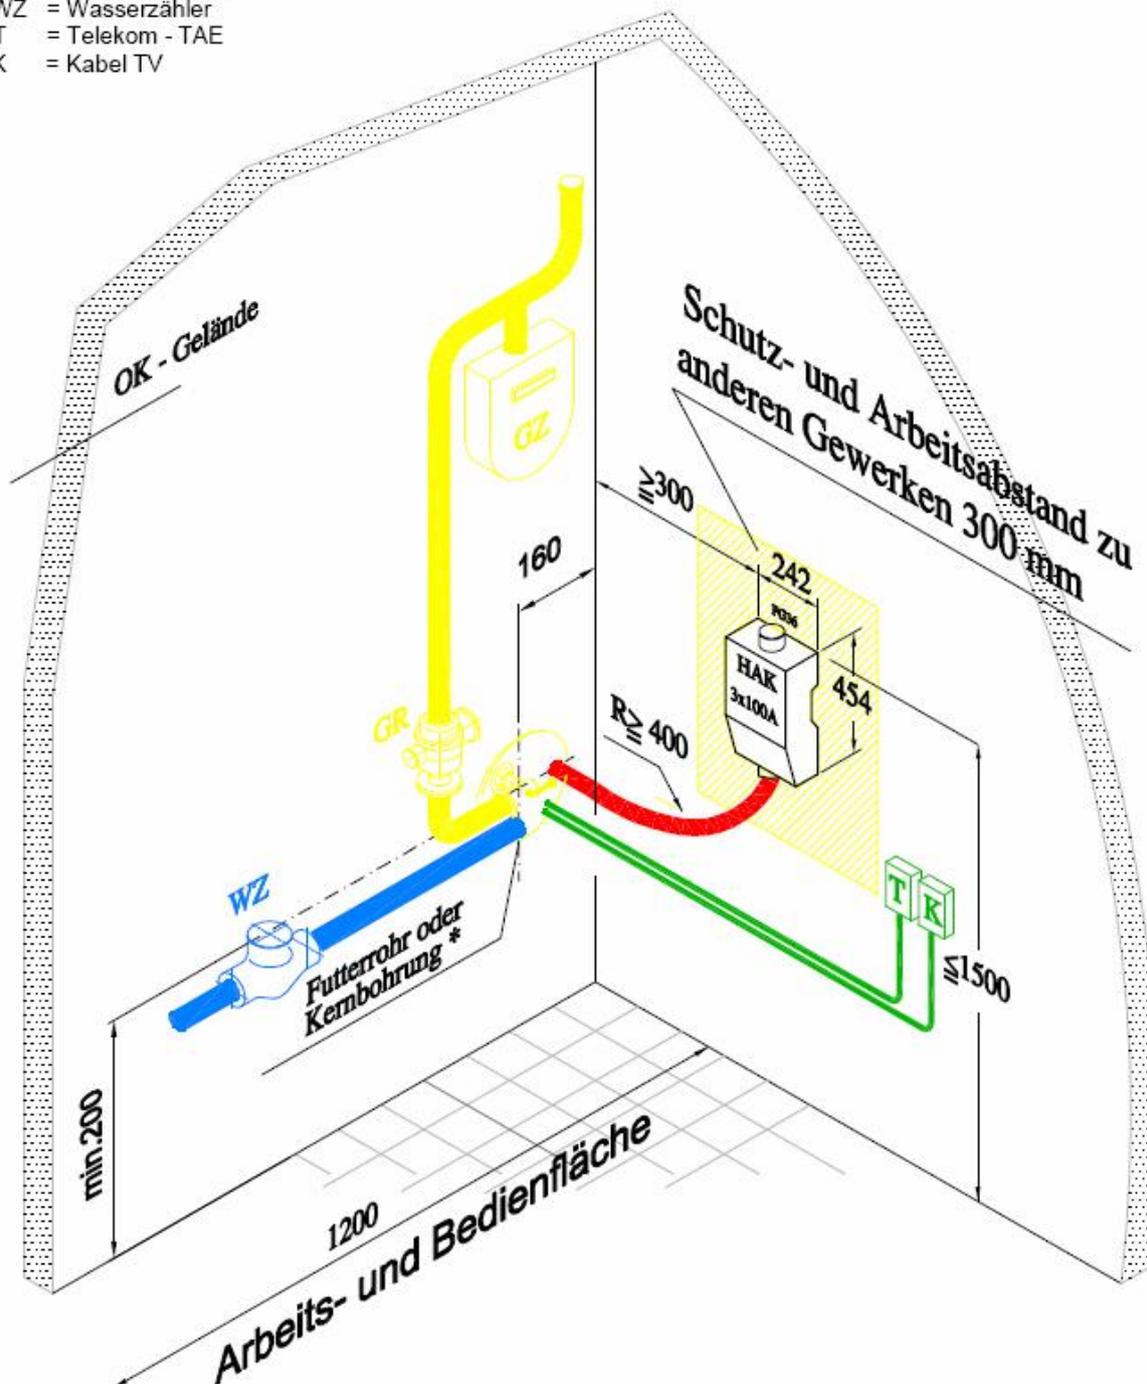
Installationsvariante Mehrspartenhausanschluss, horizontaler Einbau
